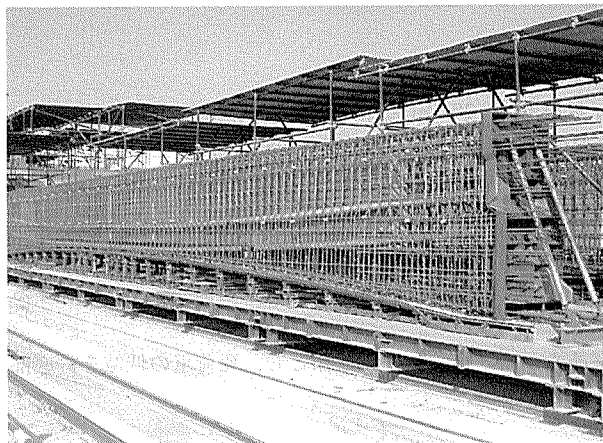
シース配置および配筋状況（鉄筋組立てエリア）
